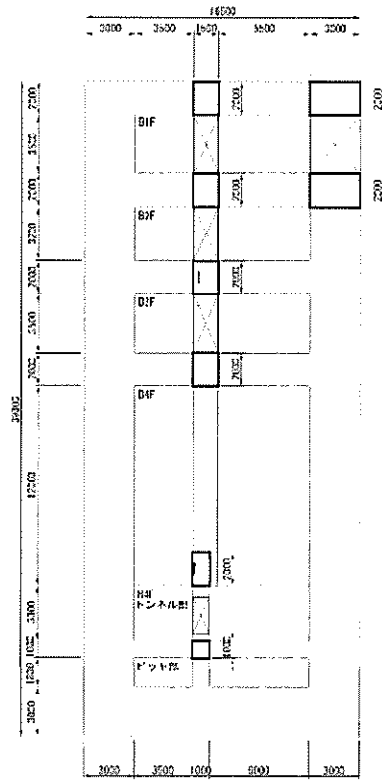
(6) 概略配筋図 (水平断面 開口部)
